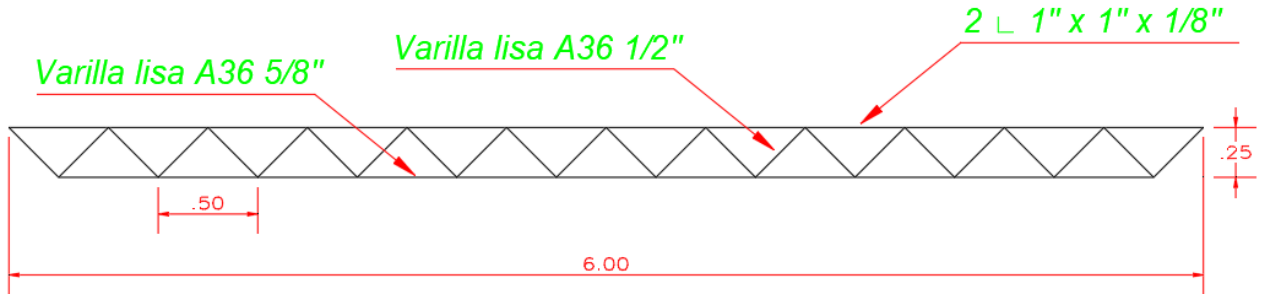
Detalle de arriostres entre viguetas @ 1.50 m (Fuente: Propia)
